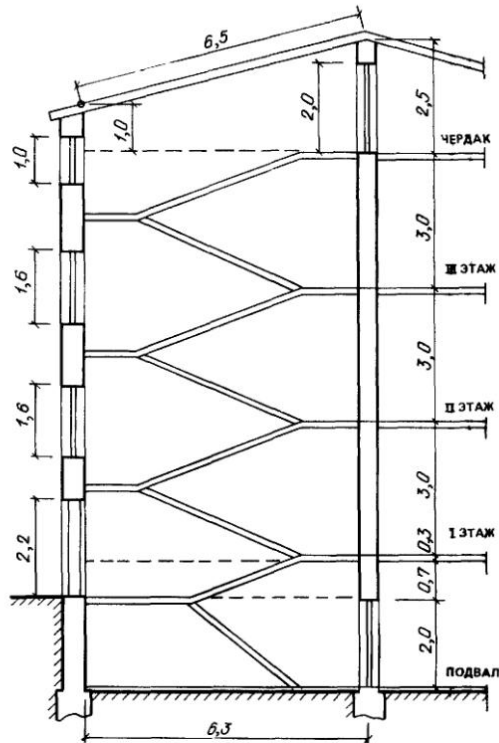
Разрез жилого здания по лестничной клетке (к примеру 8.2)
